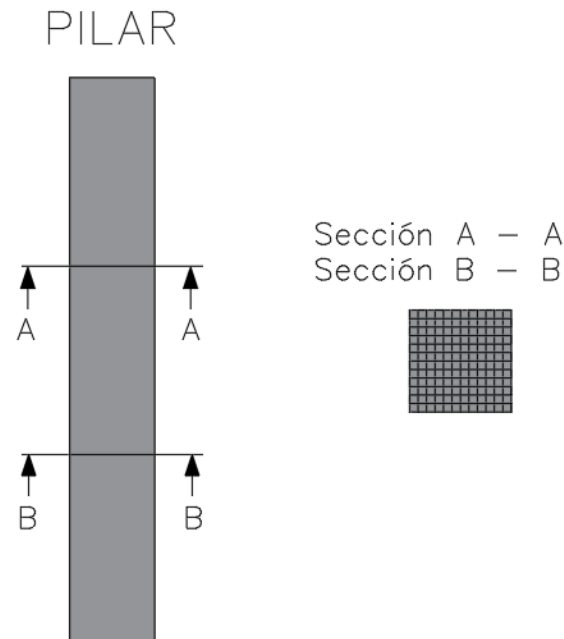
Detalle de un pilar del modelo dividido en 3 elementos finitos marcados por las secciones A – A y B – B. Ambas se componen de un modelo de 15 x 15 fibras. (Fuente: GiD)
